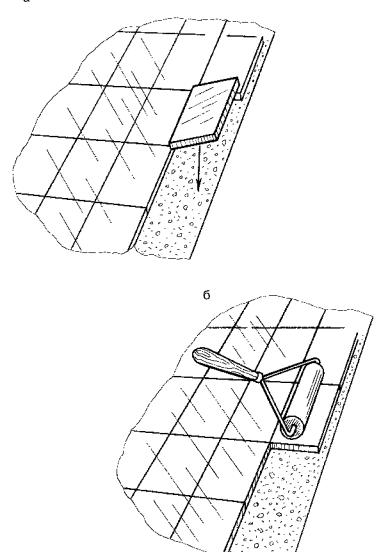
Укладка поливинилхлоридных плиток «развернутым квадратом»: а — укладка на основание; б — припрессовка плитки
